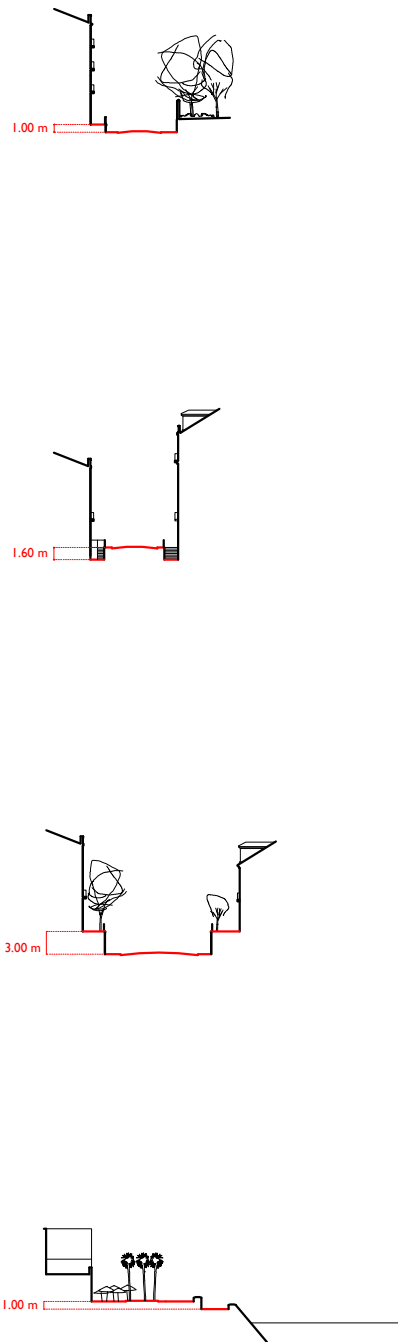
• Secção transversal da rua com múltiplos planos horizontais. Secções transversais (1:1.000).
